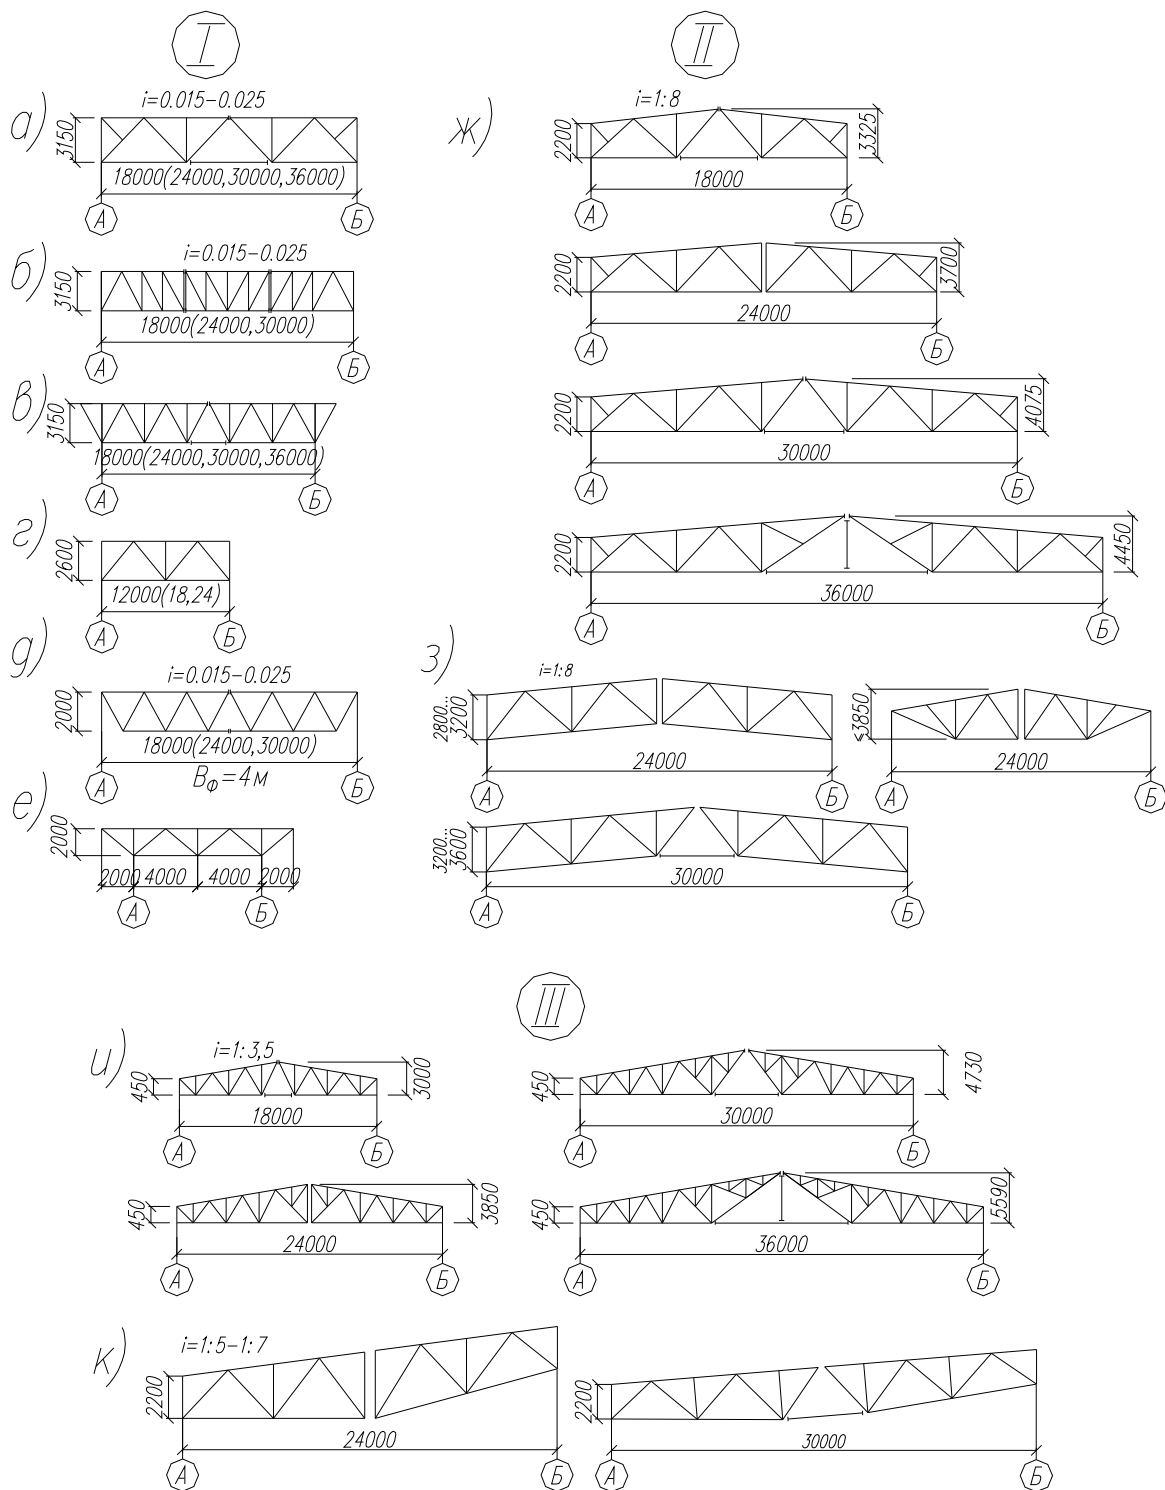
Геометрические схемы стальных стропильных ферм:
